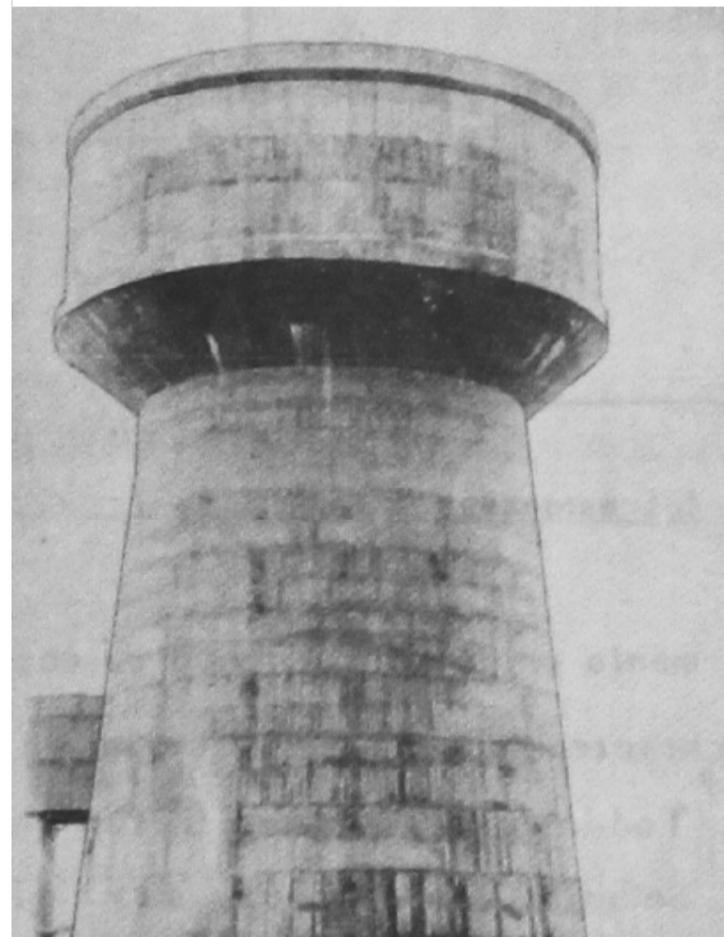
Estanque estructura soportante cilindro central y pilares radiales.
